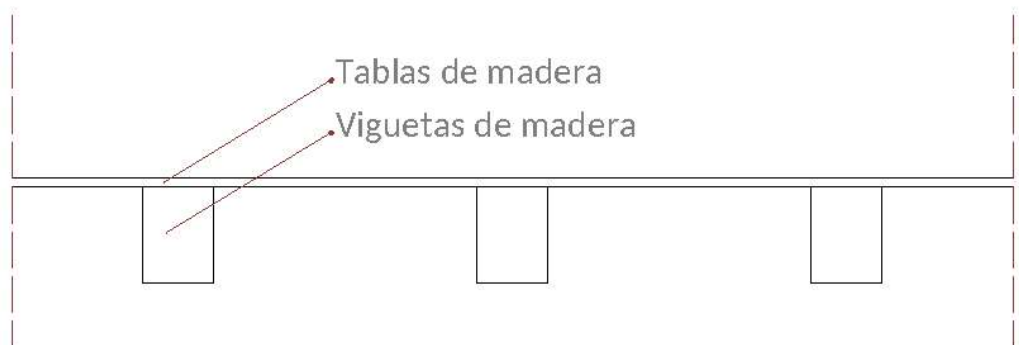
Detalle constructivo del forjado de tablas. Elaboración propia.
